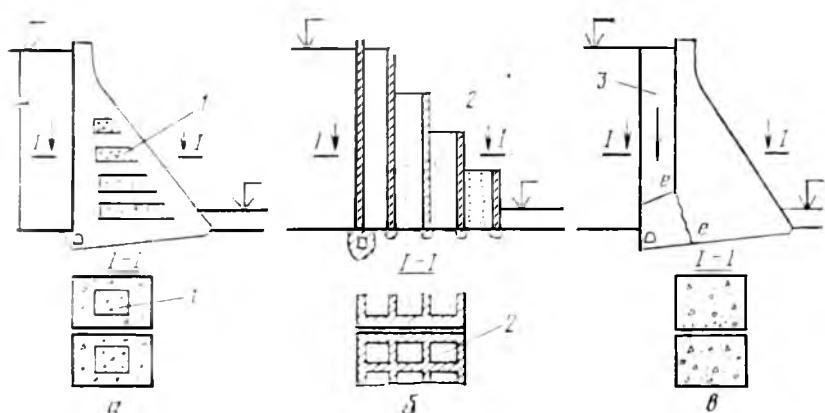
Конструкция плотин с заменой части веса бетона пригрузкой:
